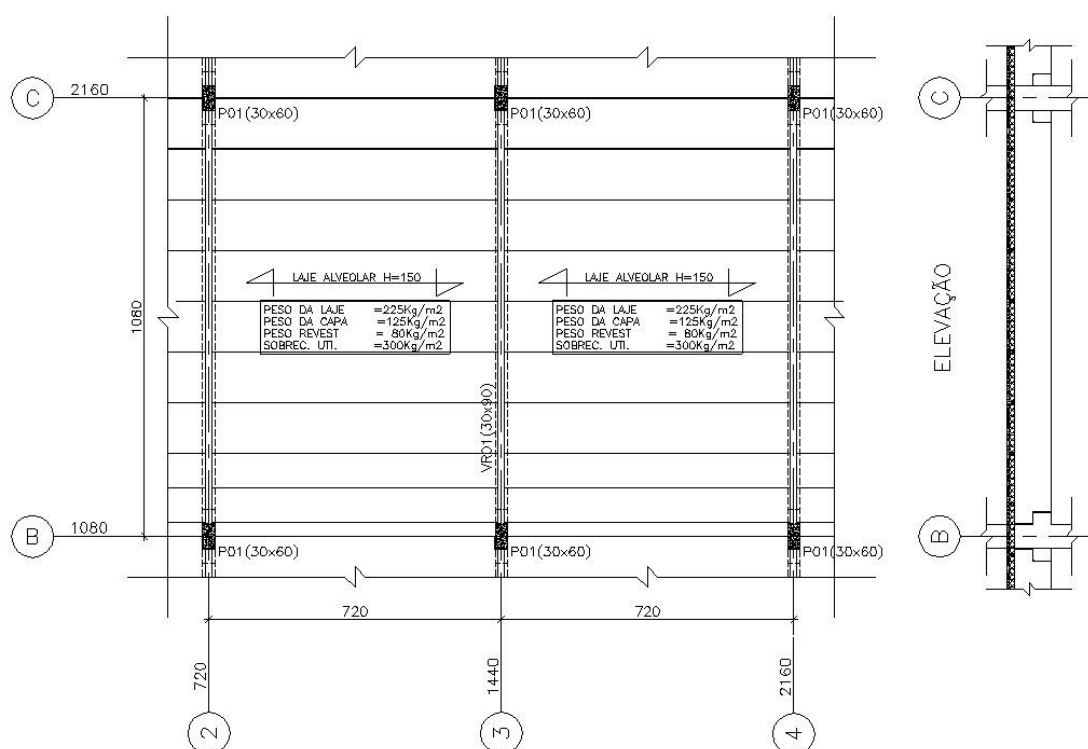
Planta do pavimento e elevação da viga VR01 (unidades em cm).
